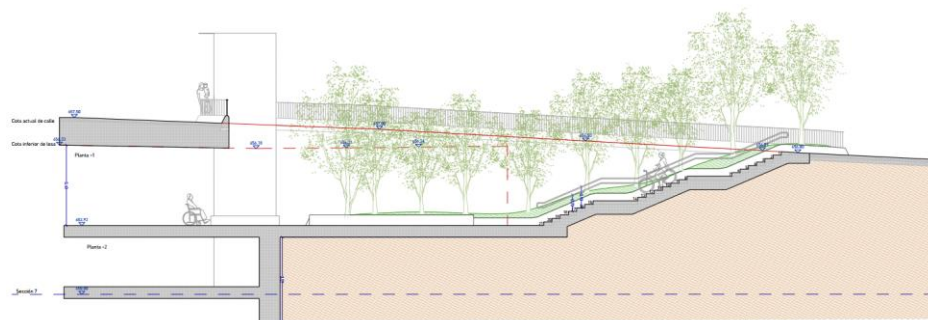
Sección longitudinal tipo de arquitectura del nuevo acceso
